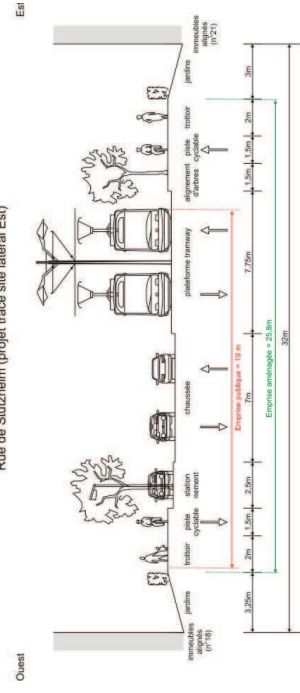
situation projetée. Coupe sur la rue de Stutzheim (Variante 1).
